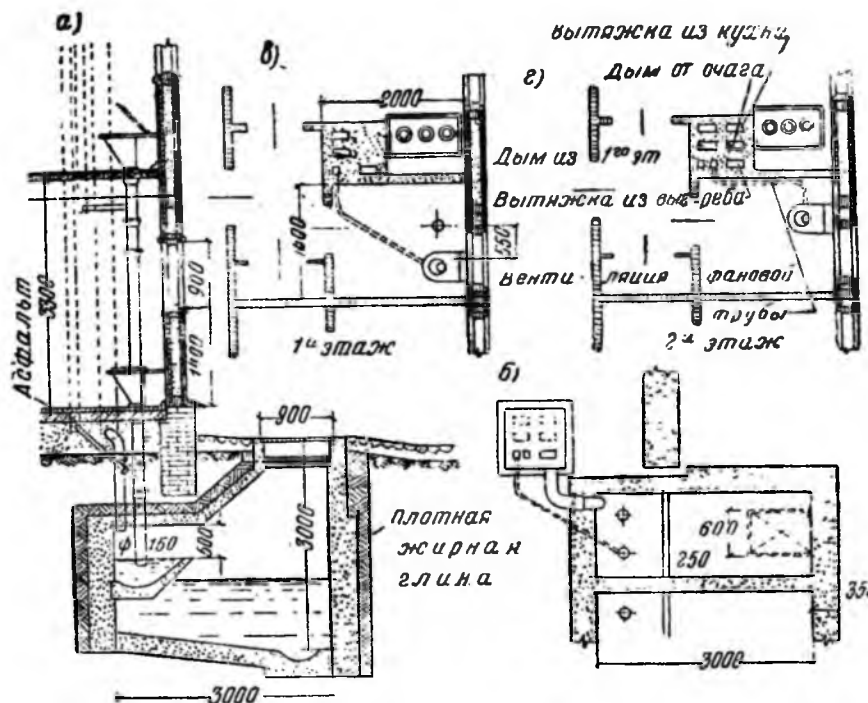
Люфт-клозет с гидравлическим затвором для двухэтажного жилого здания
